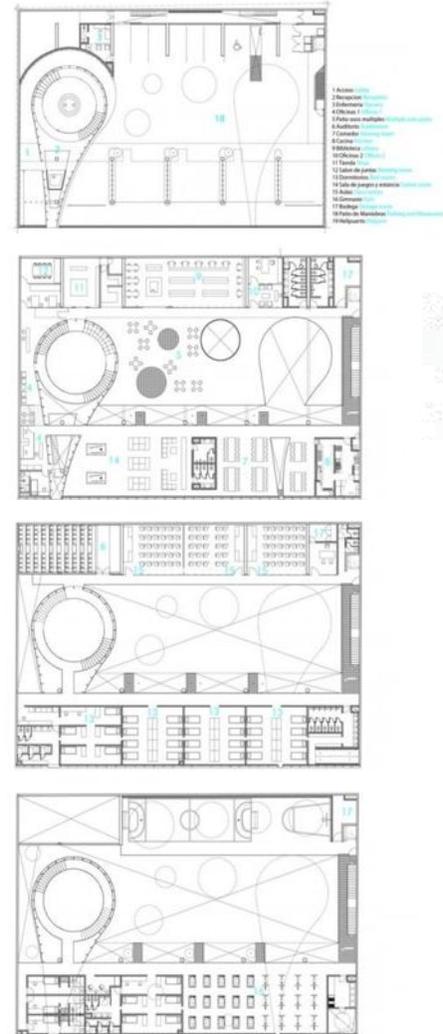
Plantas arquitectónicas de la estación del ave Fénix, Ciudad de México.
